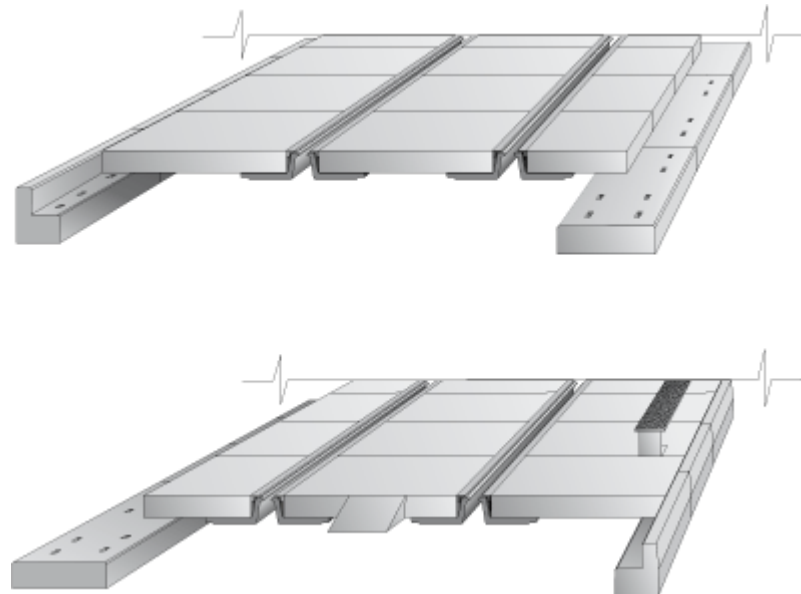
Železobetonová přejezdová konstrukce UNIS [13]
